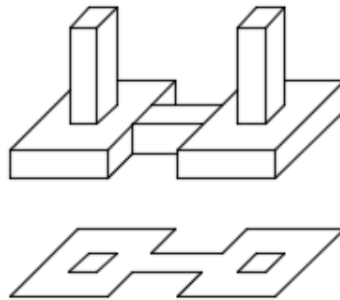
ZAPATA EN VOLADIZO O LIGADA.
